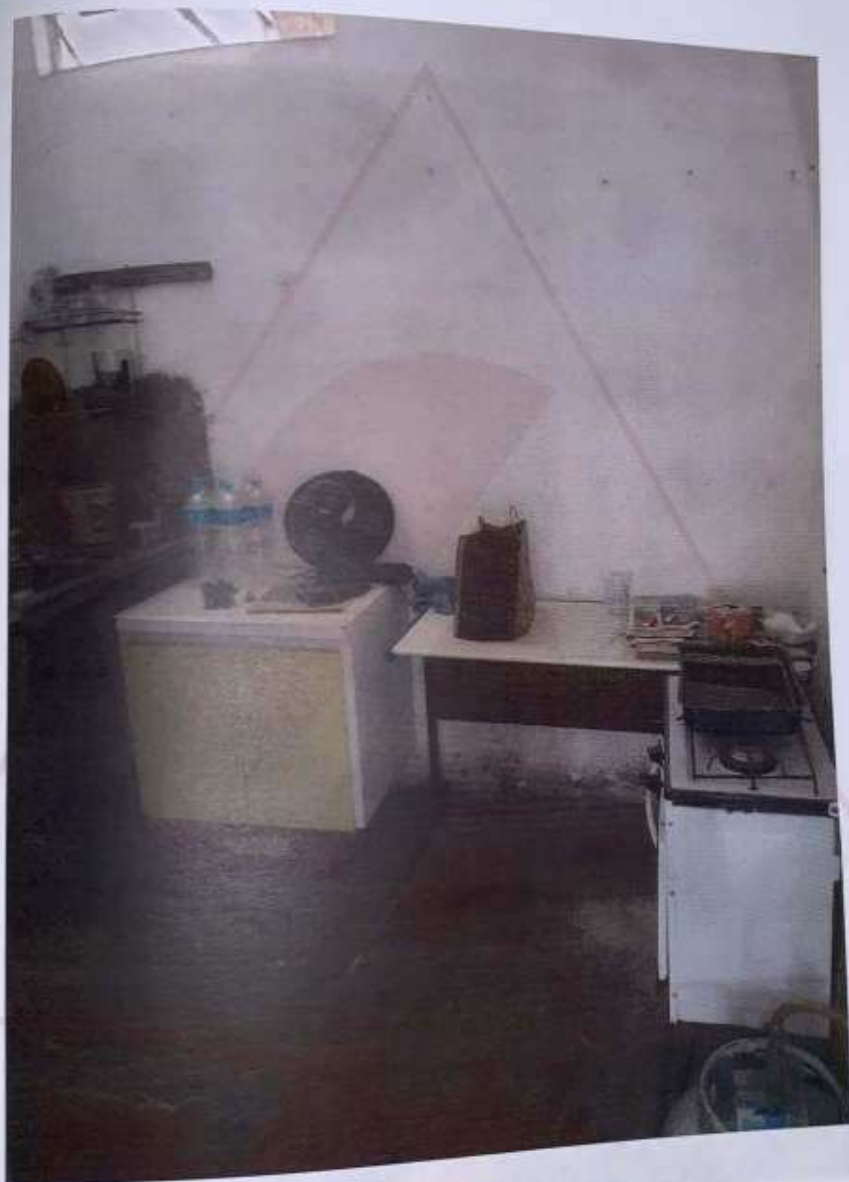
OUTRA VISTA INTERNA DA EDIFICAÇÃO.
